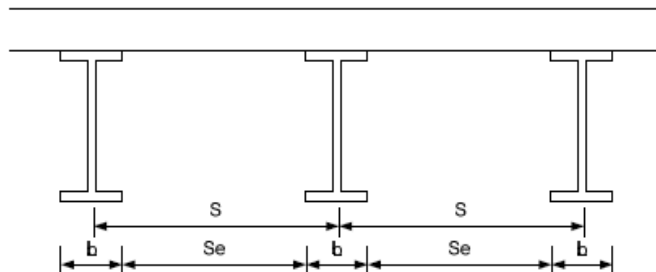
Longitud equivalente Se para secciones transversales con tablero de hormigón armado
